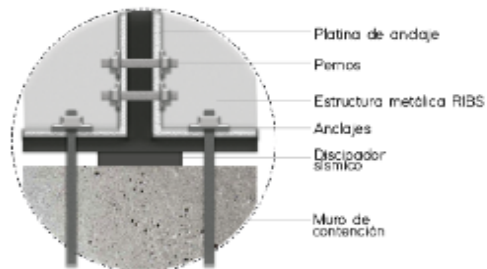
Detalles constructivos de anclajes en fachada y columna ribs (costillas). Elaboración propia.
